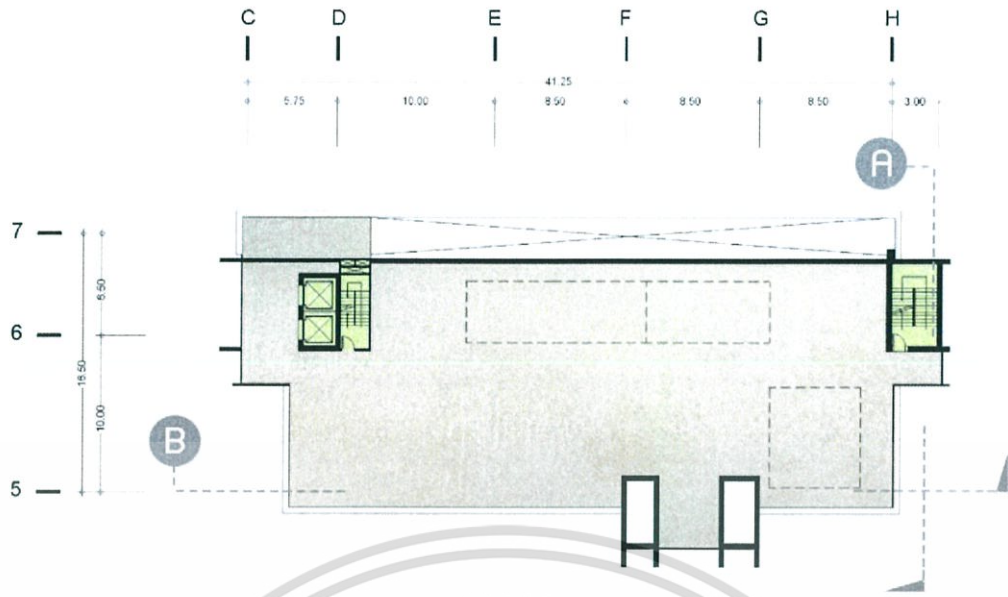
แสดง 35<sup>th</sup> FLOOR PLAN
